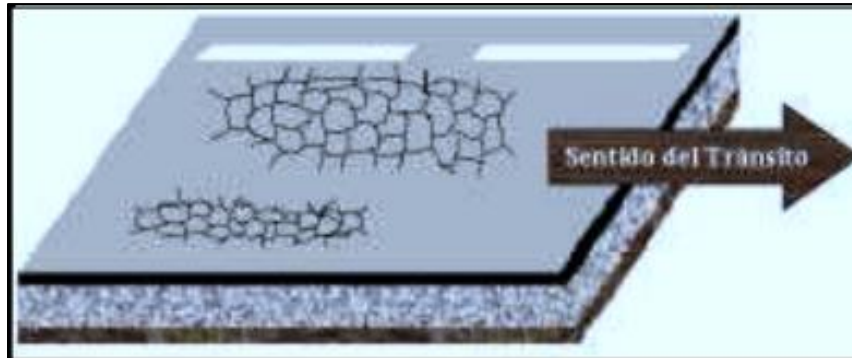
Esquema fisura piel de cocodrilo
